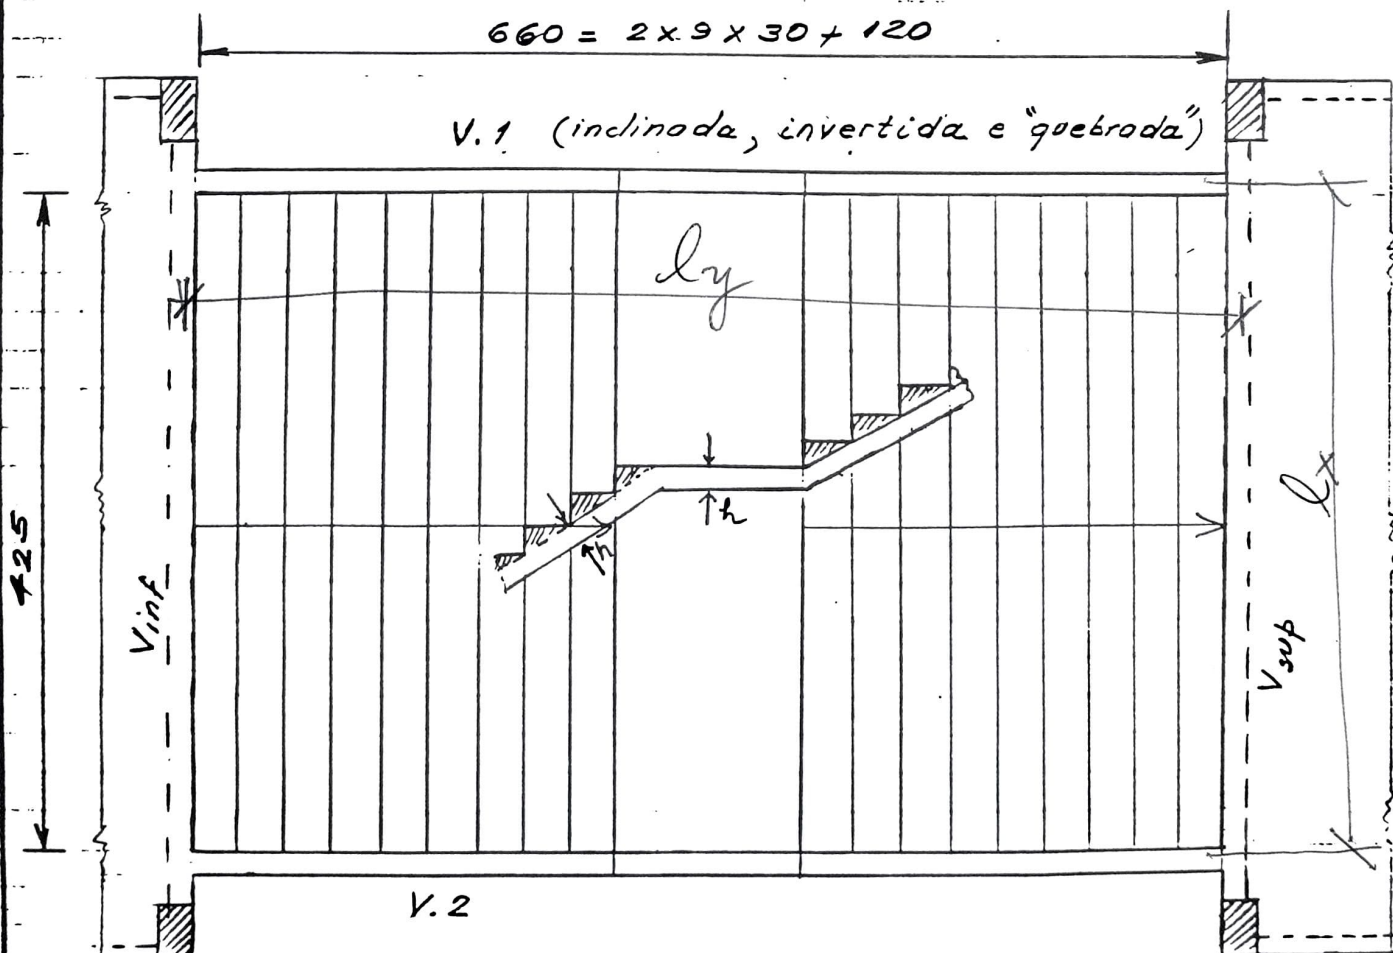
Exemplo de escada em laje armada em cruz com vigas no perímetro (Exemplar)
